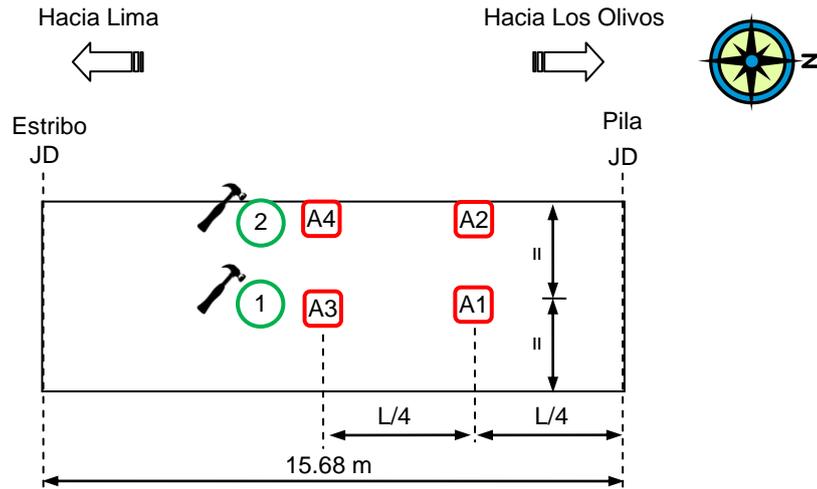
Disposición de sensores y puntos de impacto para el ensayo de los tramos del puente Izaguirre en Panamericana Norte. Ensayo en tramo simplemente apoyado.
